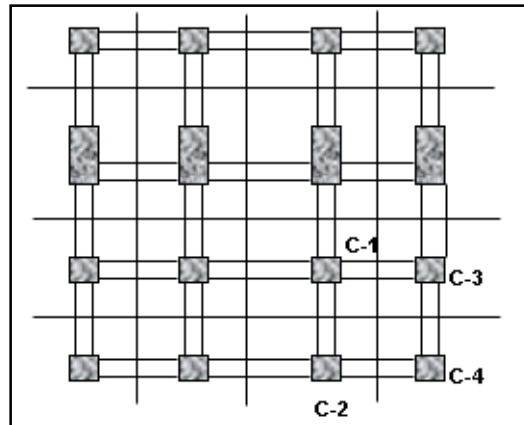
Posicionamiento de los tipos de columnas para el predimensionamiento.
